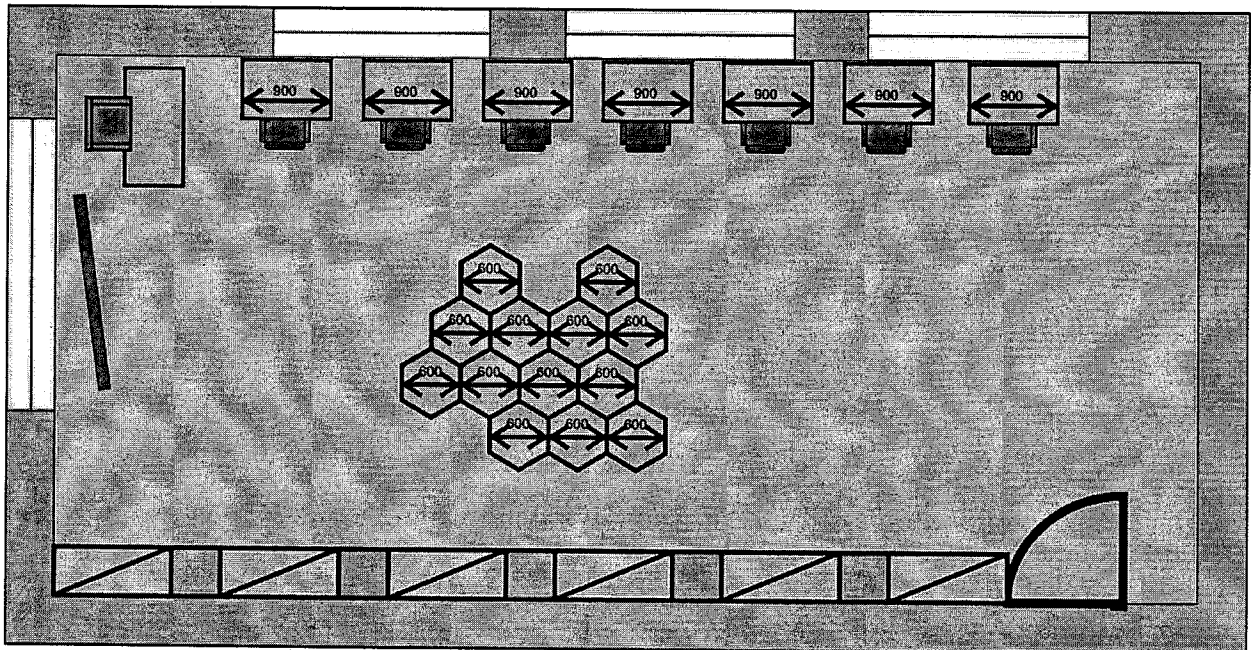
План размещения оборудования в помещении «Робоквантум»
